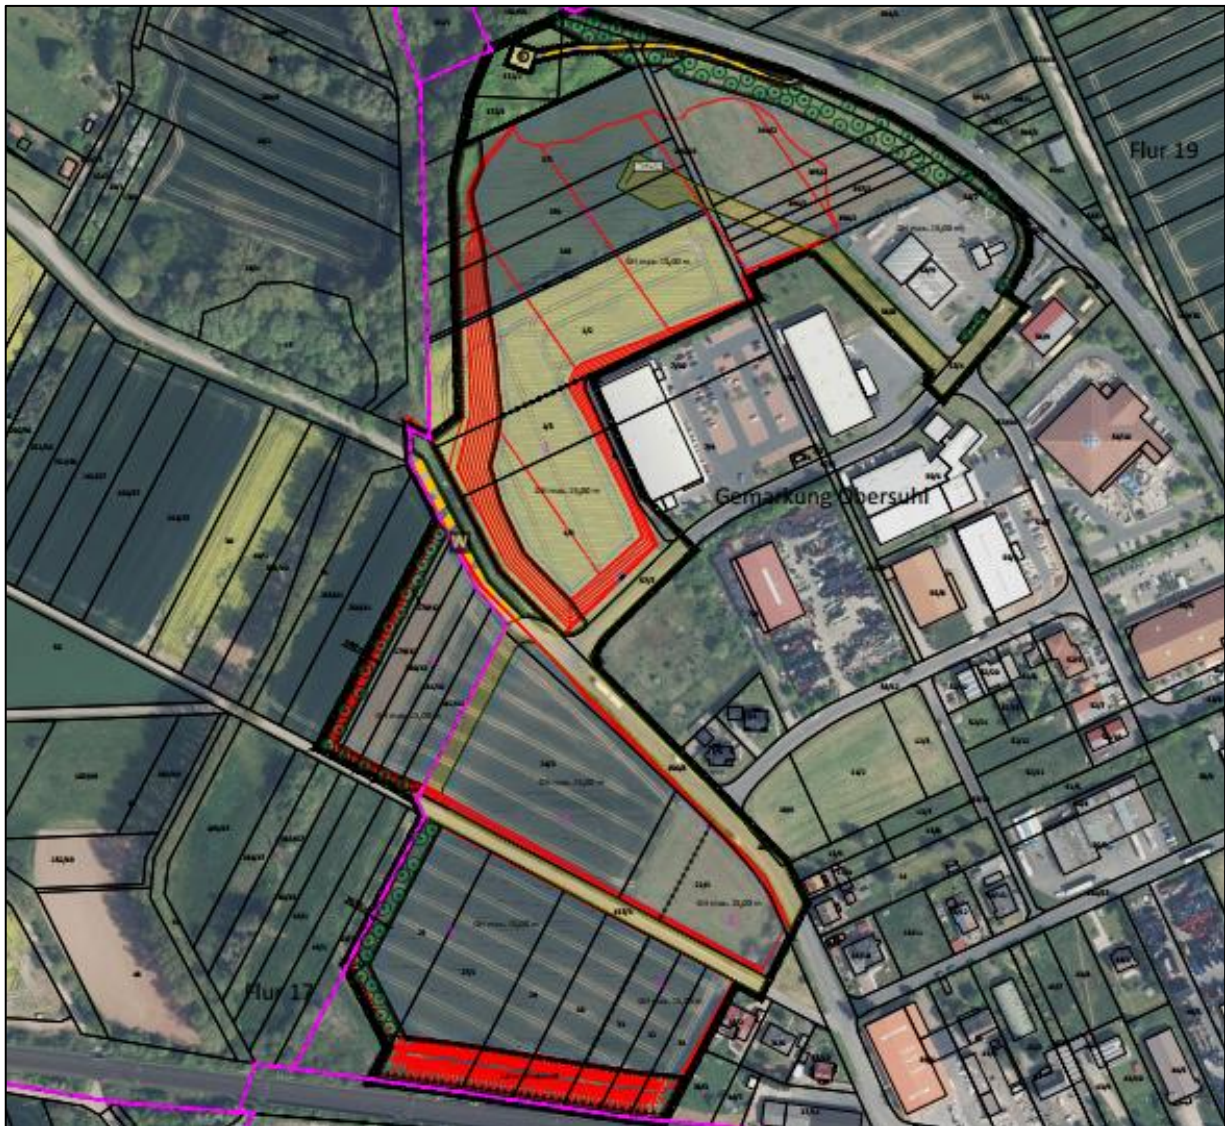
Überichtskarte Plangebiet, geplante Geländeprofilierung, Hintergrund DOP/ALK (ohne Maßstab) (Quelle: Rebo consult Ingenieurgesellschaft, Unterbreizenbach, Stand Geländeauffüllung 2017, Entwurf Geländeauffüllung mit Lärmschutzwand 2018)
